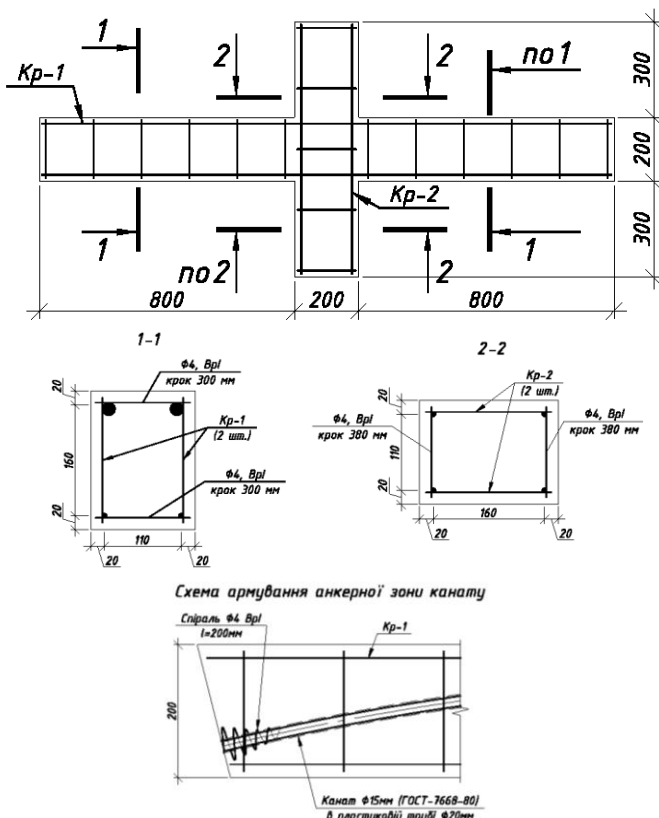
Схема армування зразків не напружуваною та поперечною арматурою
